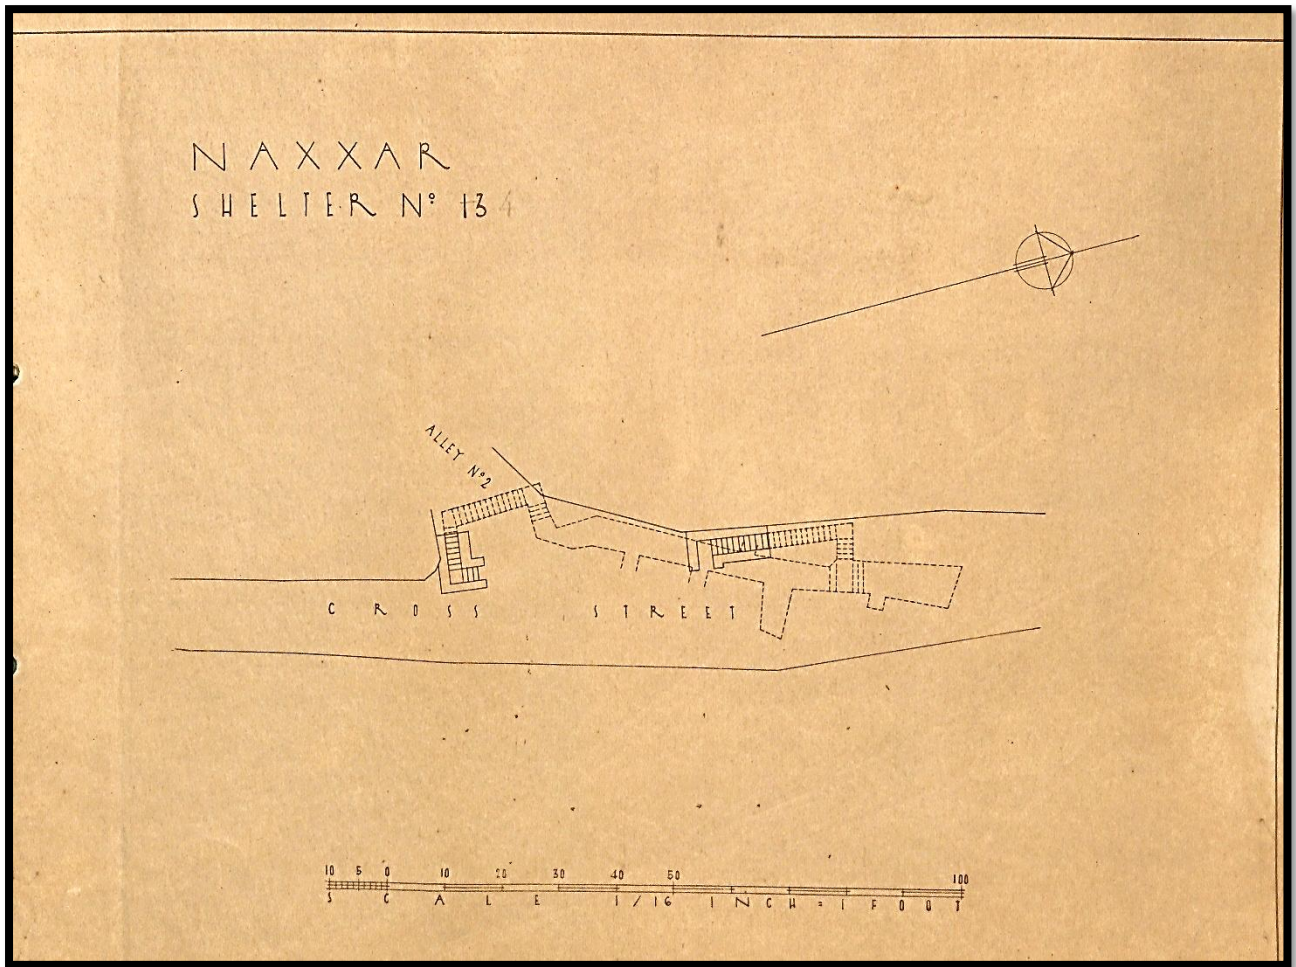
Planta do Abrigo nº13 (4) "Cross Street – Alley nº2"
